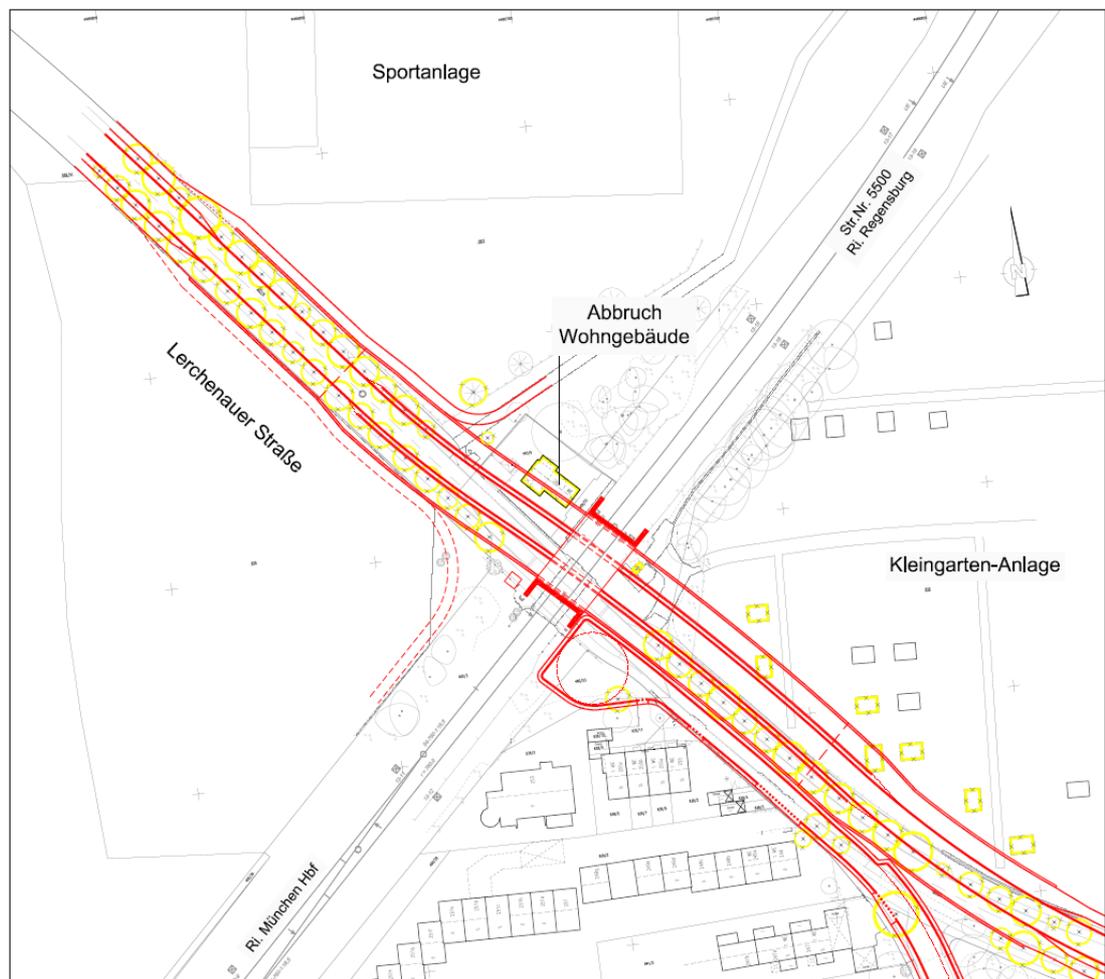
Lageplanausschnitt Variante 1 - geradlinige Straßenführung
